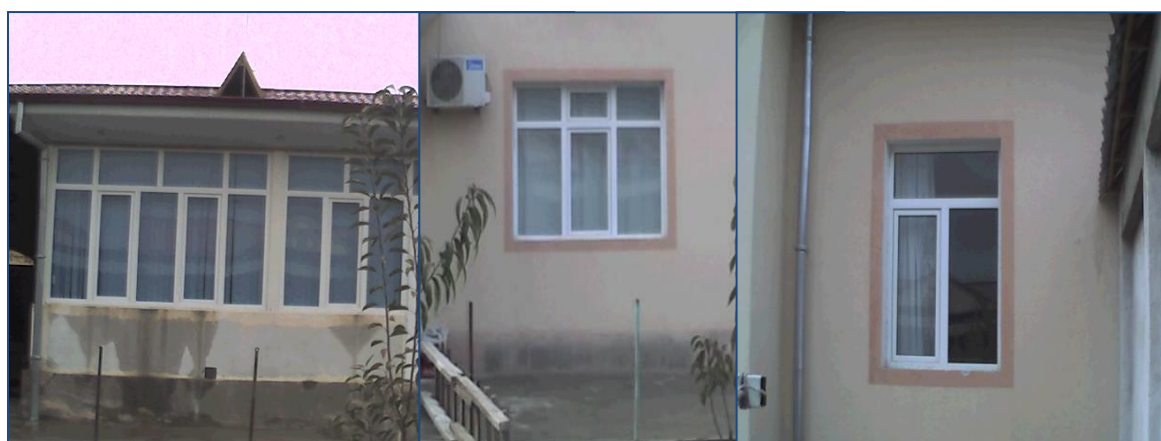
Задний фасад здания (внутренняя сторона здания)
